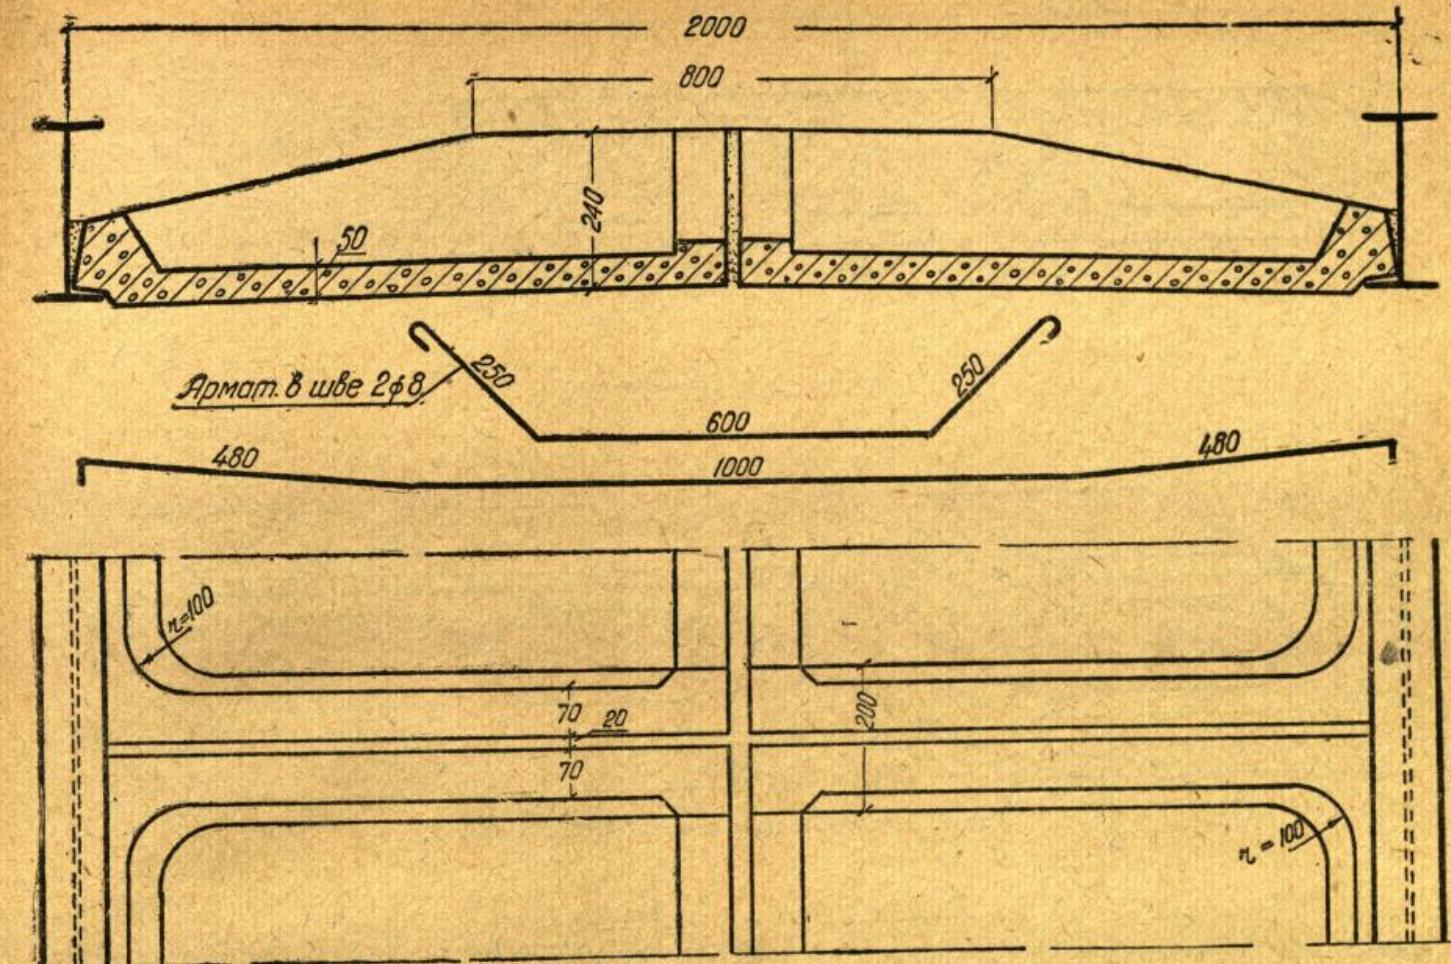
Междуэтажное перекрытие с нижними шлакозольными бетонными плитами.
